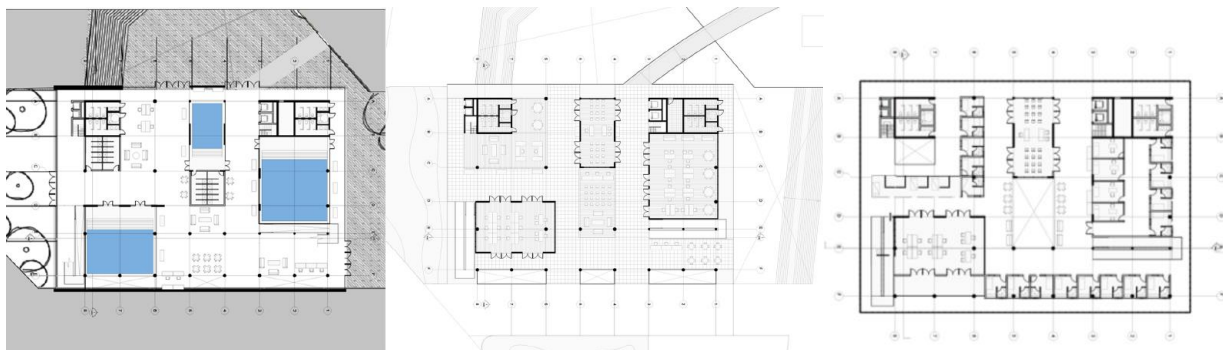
Planos de planta del proyecto propuesta, Elaboración propia, 2021.
